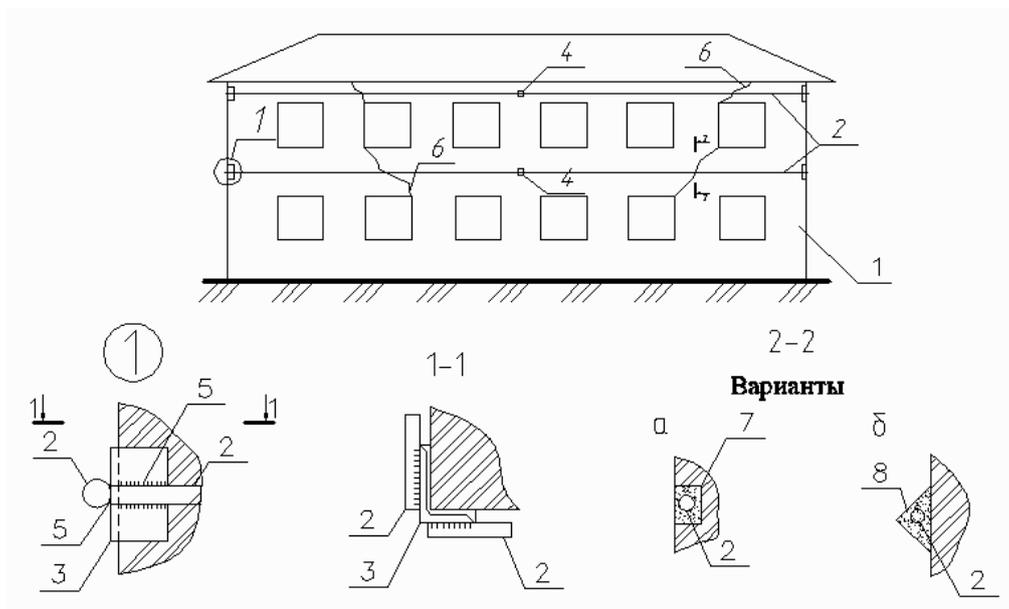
Усиление стен устройством напряженных металлических поясов с наружной стороны здания: 1 – деформируемое здание; 2 – стальные тяжи; 3 – прокатный профиль из уголка; 4 – стяжные муфты; 5 – сварной шов; 6 – трещины в стенах; 7 – штраба в стене для тяжа, заполненная цементно-песчаным раствором; 8 – промежуточный карниз из цементно-песчаного раствора
